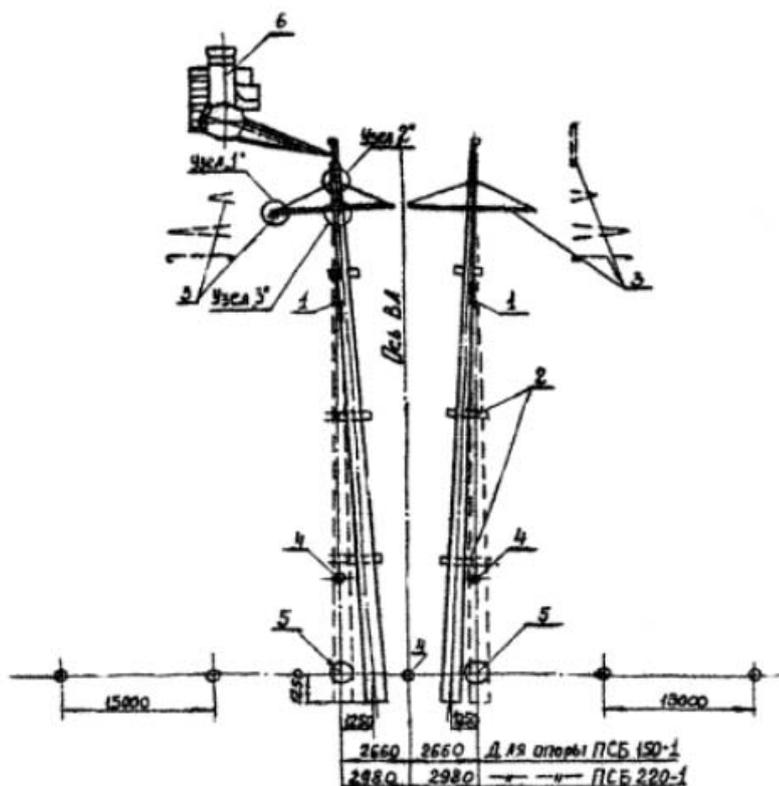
Схема выкладки стоек опоры и оснащение их металлическими деталями для подъема краном КВЛ-8
